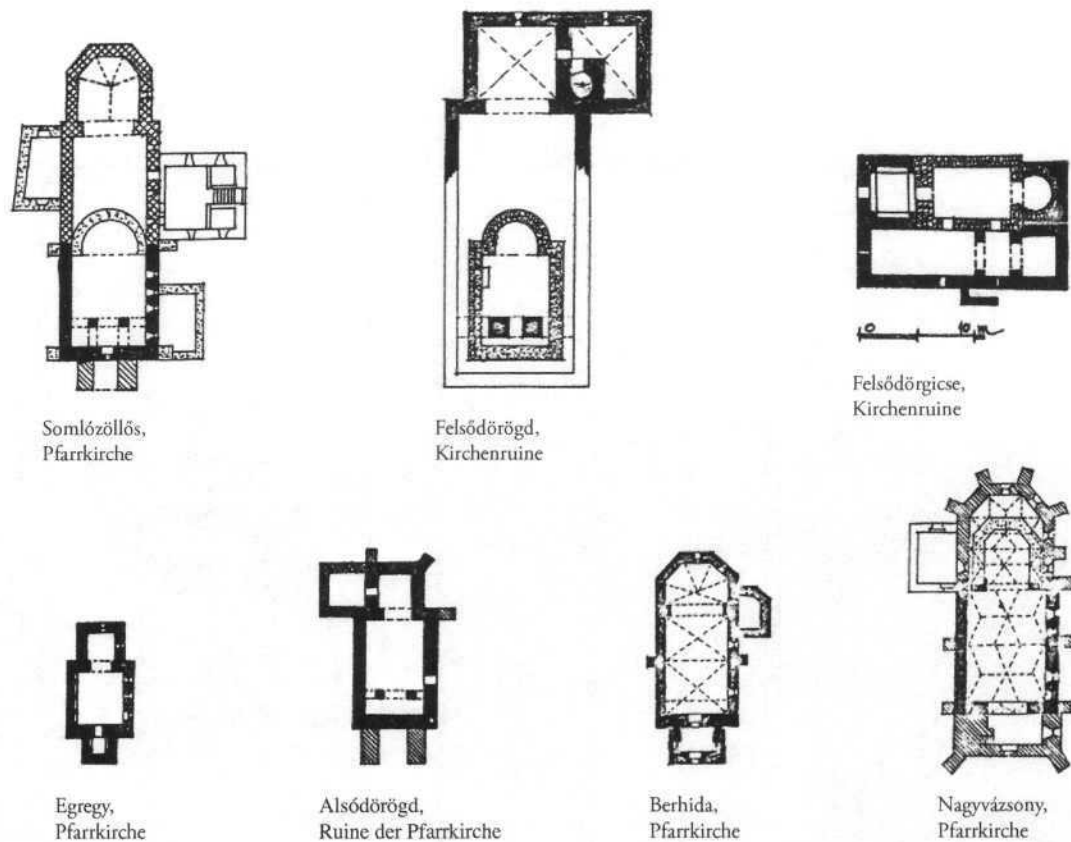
Grundrisse mittelalterlicher Kirchenbauten in Ungarn
